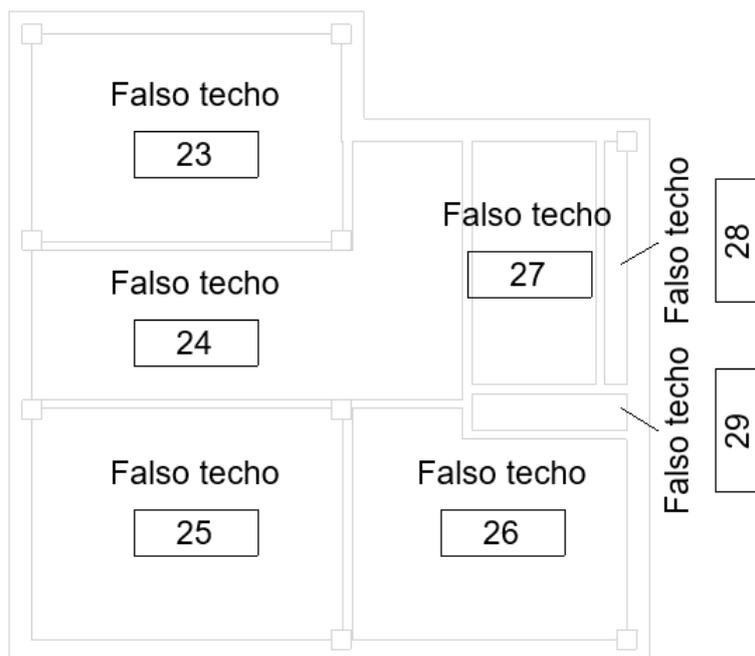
Espacios de falso techo de planta primera colocados y nombrados. Fuente: propia
